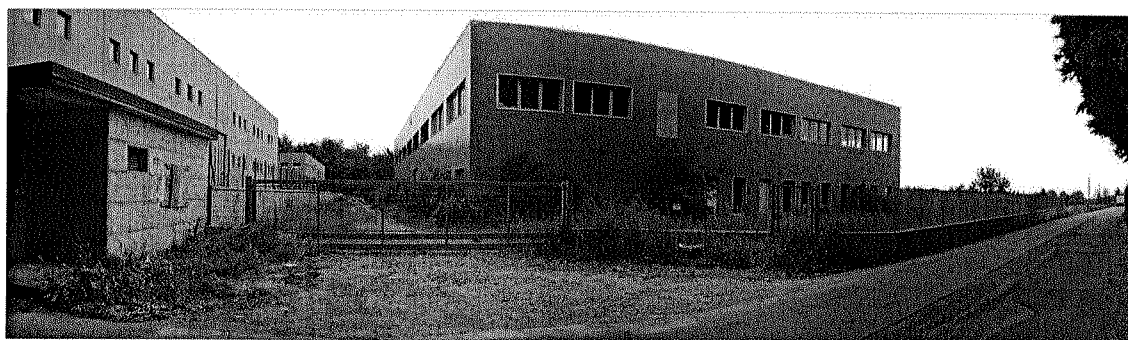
vista dell'ingresso carrale e pedonale su via Lombardia – lato ovest
